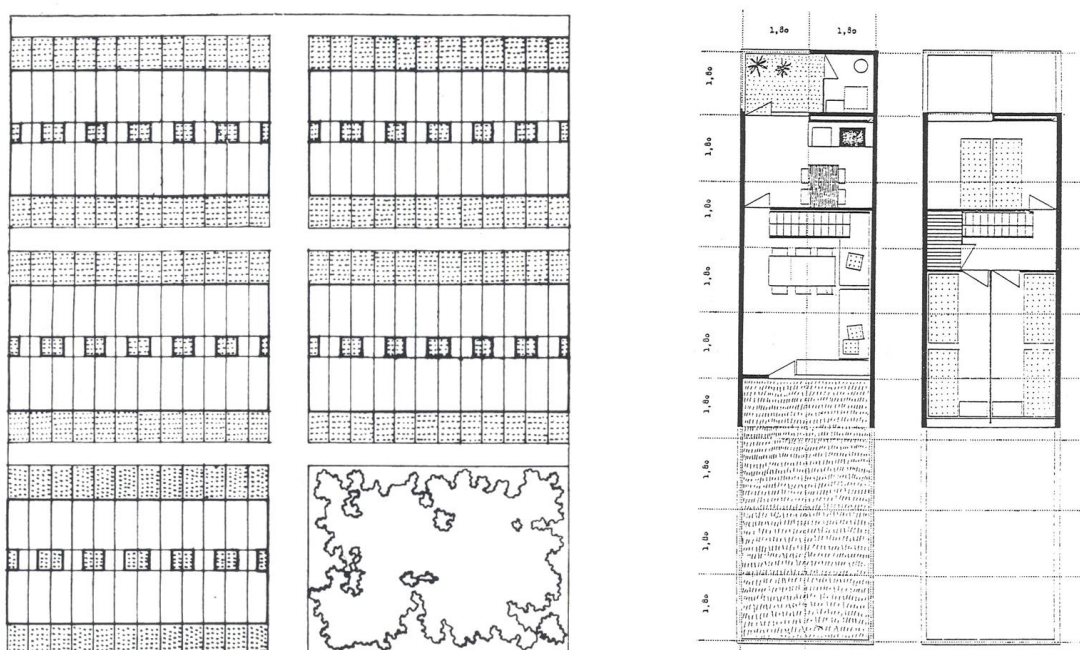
Unidad base de planeamiento (izquierda) y planta tipo de vivienda (derecha) del poblado dirigido de Entrevías. Montaje de la autora. Fuente: Hogar y Arquitectura nº 34, p. 14 y 25.
